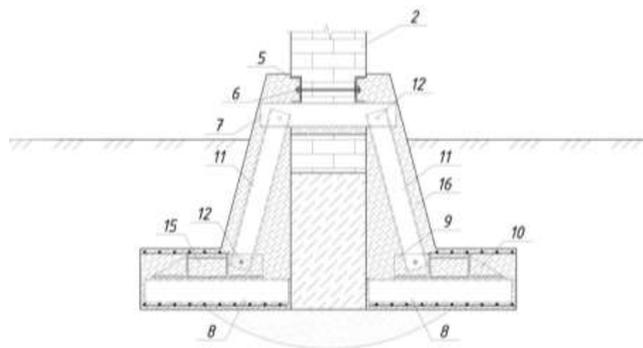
Готовый к эксплуатации усиленный ленточный фундамент несущей стены с устроенной железобетонной обоймой
